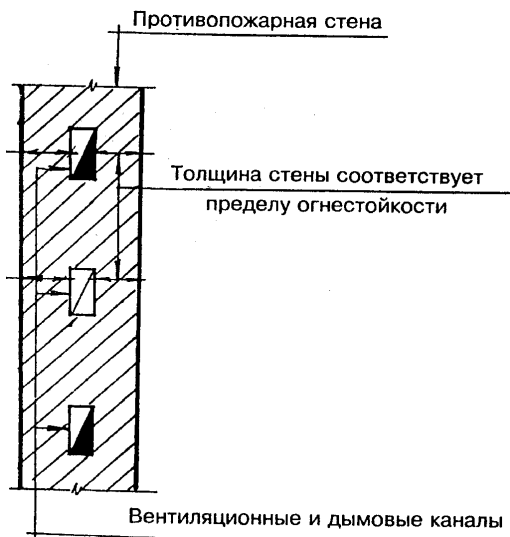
Размещение вентиляционных и дымовых каналов в противопожарных стенах
